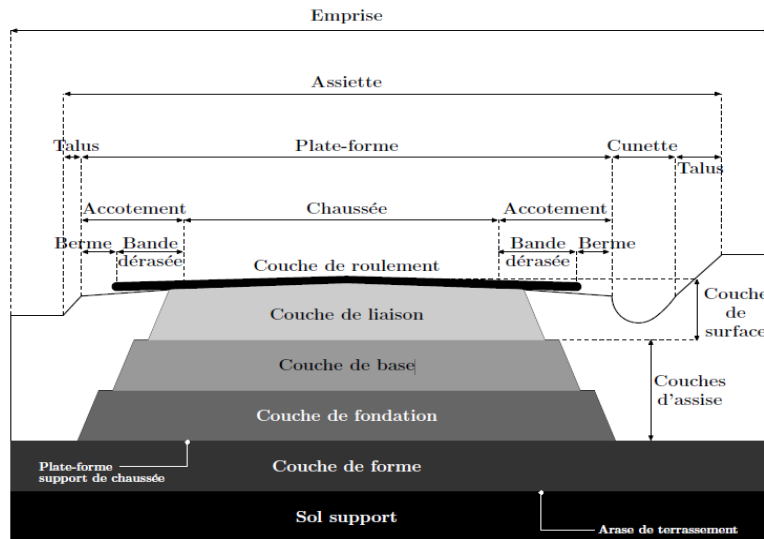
COUPE TYPE D'UNE CHAUSSÉE (LCPC 1994)
